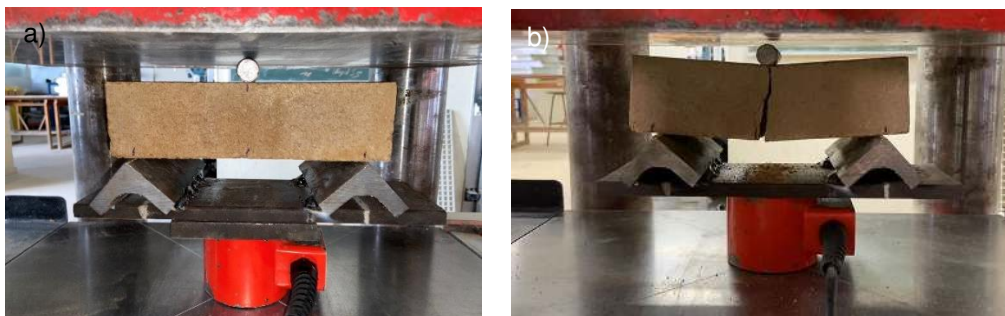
Ensaio de tração por flexão: a) montagem do provete ; b) provete após o ensaio.
